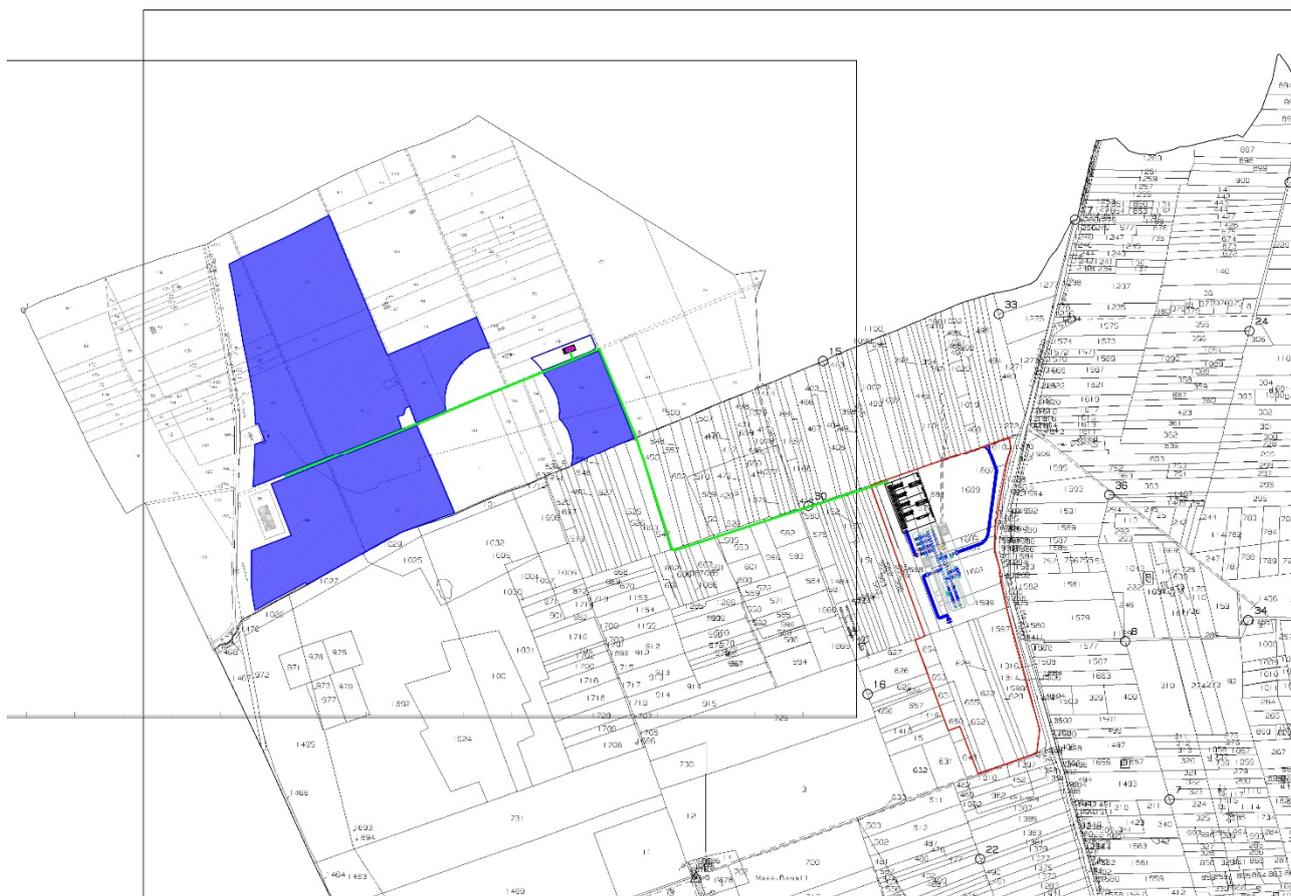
Estratto mappe Catasto Terreni con cavidotto di connessione
